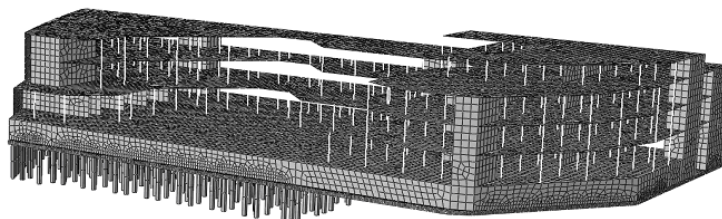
Система сооружение – свайный фундамент - грунтовое основание
